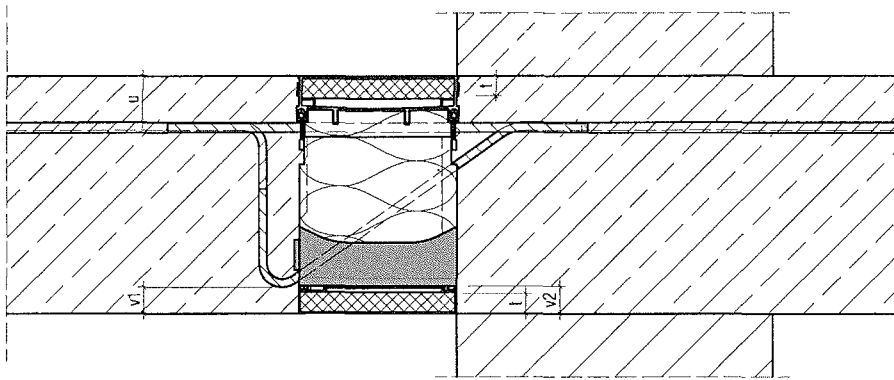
Schöck Isokorb Typ K und Typ KF (F30/F90)
